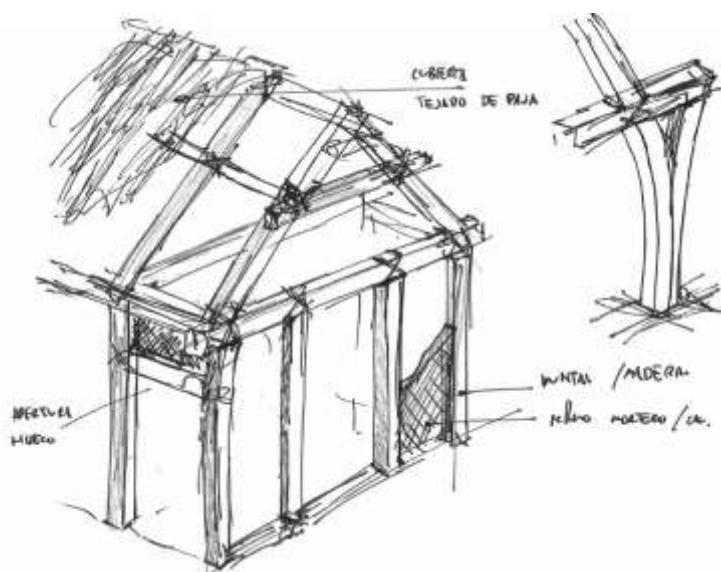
esquema de una construcción de un piso para grandes dimensiones.
